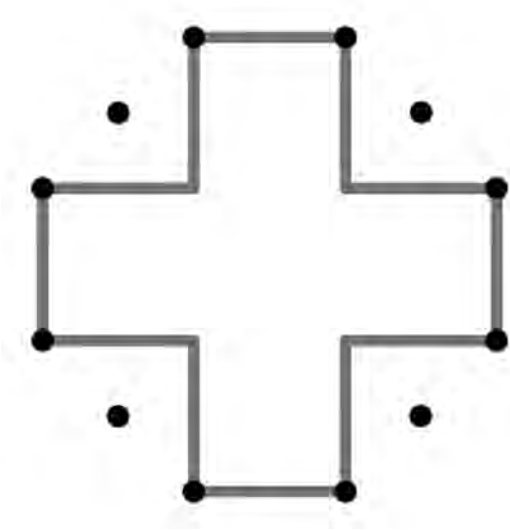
Grundriss des Pavillons oder „Haus auf Säulen“.
